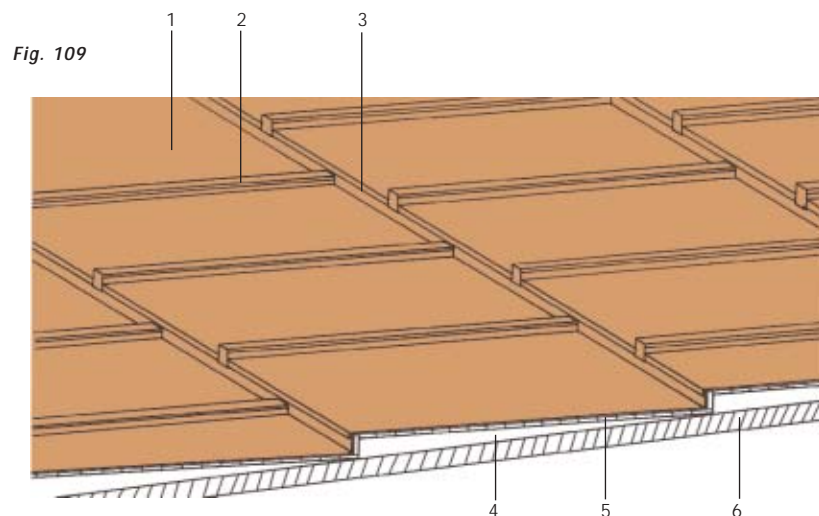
Detalhe da vertente com junta escalonada transversal e juntas elevadas com caibro.
